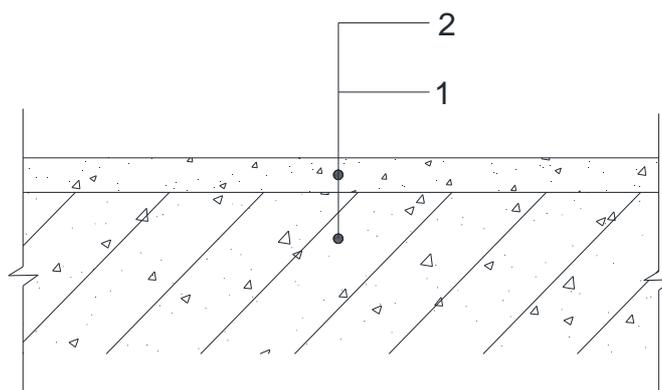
水泥砂浆、混凝土地面防滑构造示意图
